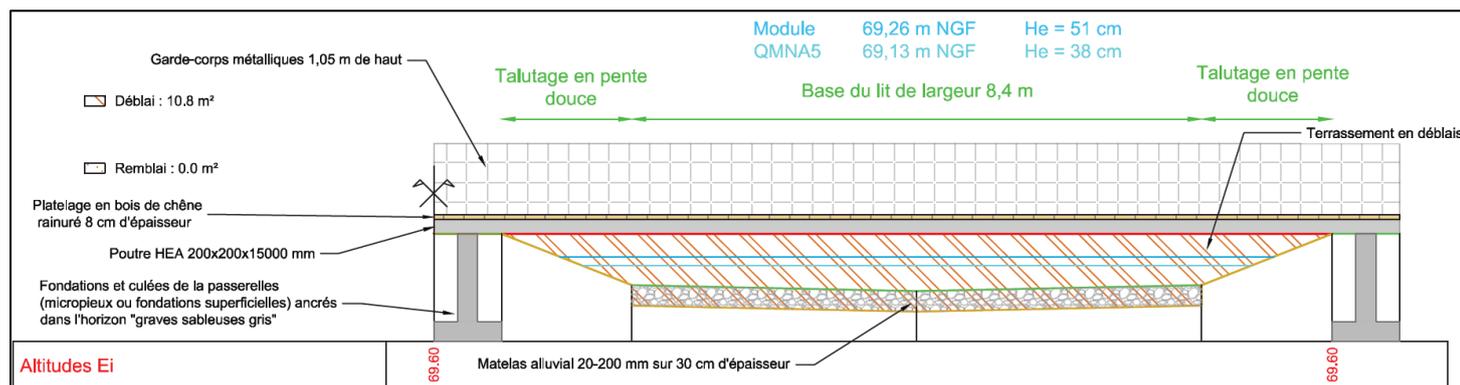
Profil en travers au droit de la passerelle (PT2)
